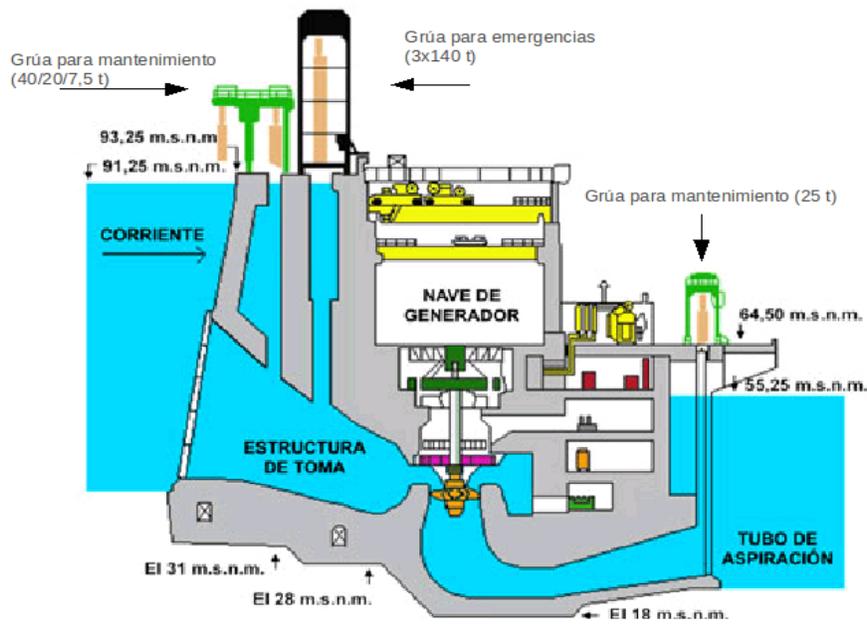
Corte transversal de la Casa de Máquinas de Planta Caruachi.
